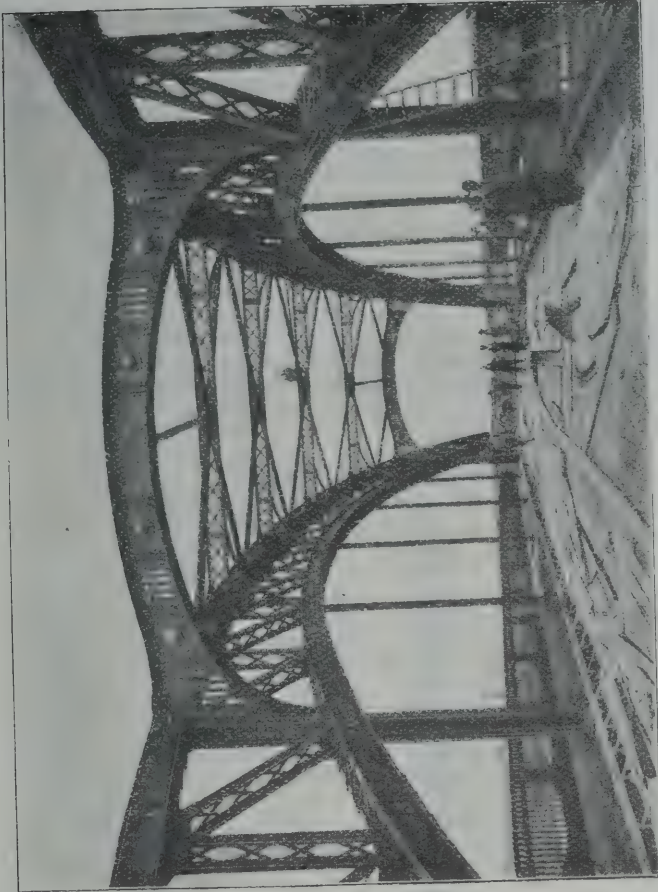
Straßenbrücke für Hauptstraßen (Hauptträger Fachwerkbogen mit Zugband)
